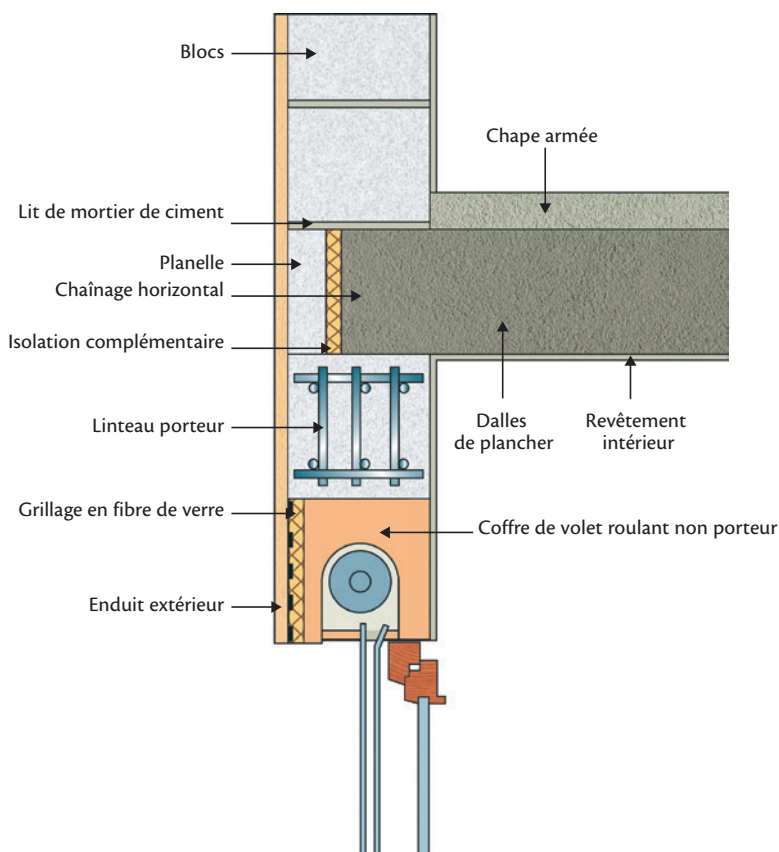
Pose d'un plancher sur linteau en béton cellulaire
